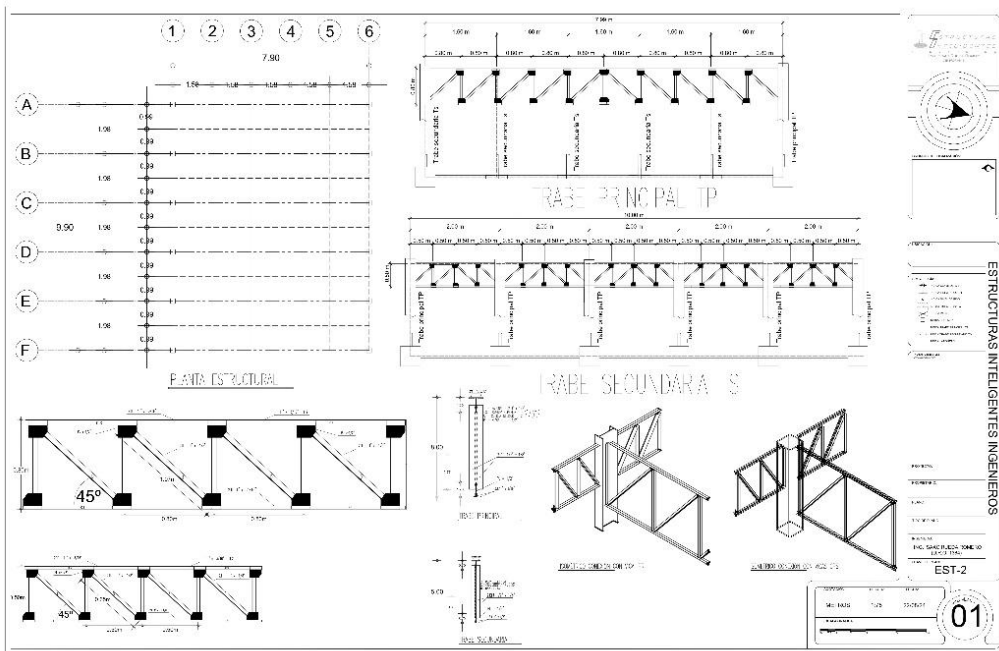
Propuesta de almacén y armado de traves para la estructura.
